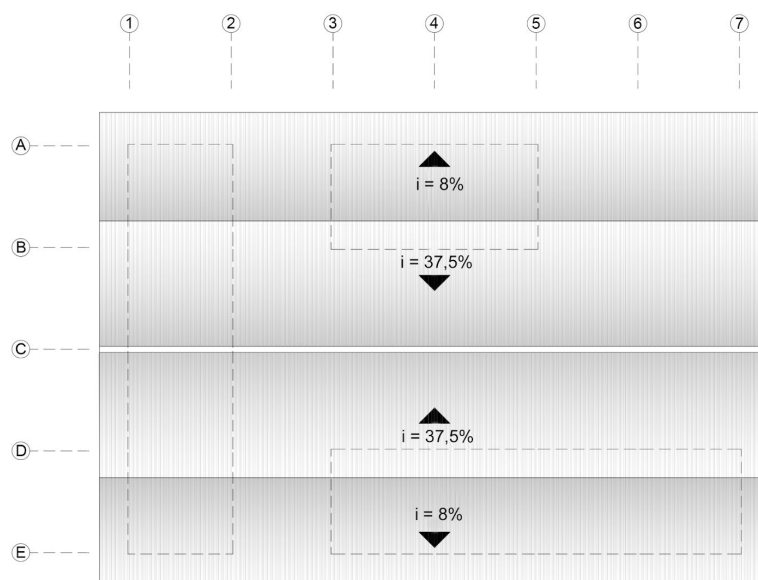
Planta de cobertura / Fonte: Autoria do grupo.
